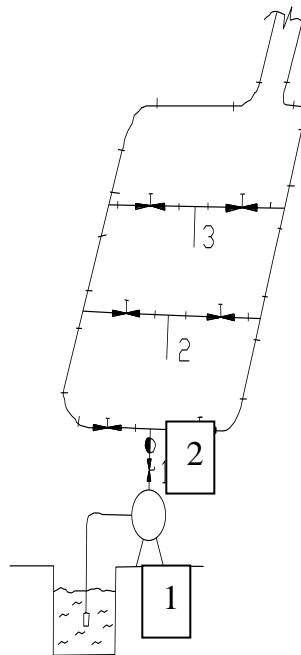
Гидравлическая схема расположения оборудования и трубопроводов в насосной станции.
